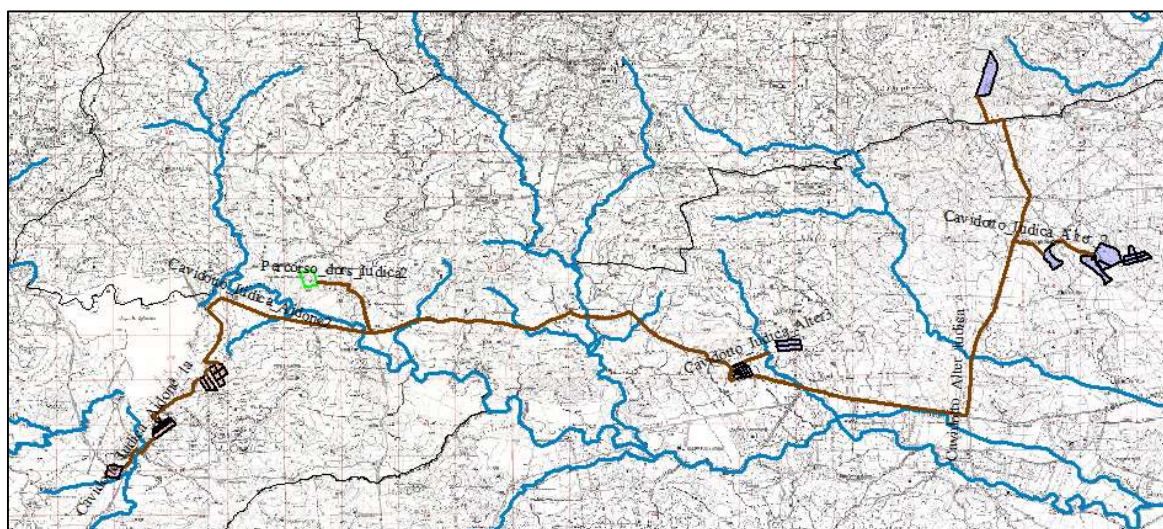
stralcio planimetrico su IGM del layout di impianto
